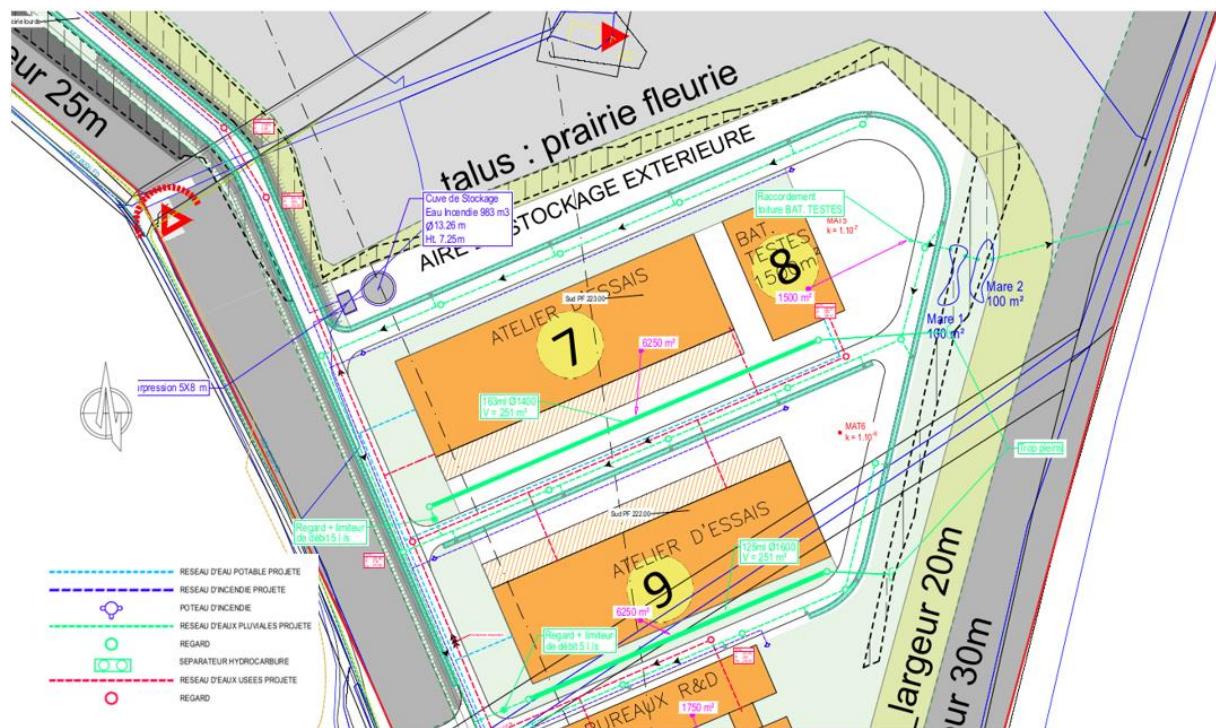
PLAN DES RÉSEAUX HUMIDES – EXTENSION SUD 1/2 (SOURCE : OTE, NOVEMBRE 2024)
